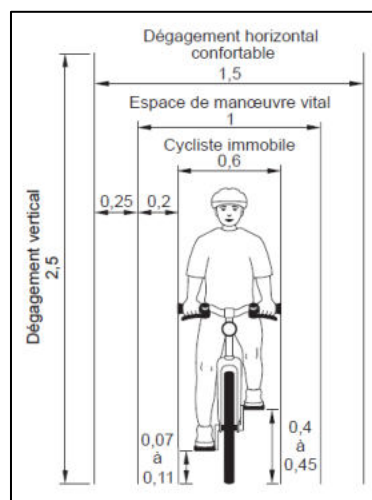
Dégagement vertical et horizontal minimal d'un cycliste (dimensions en mètre)
